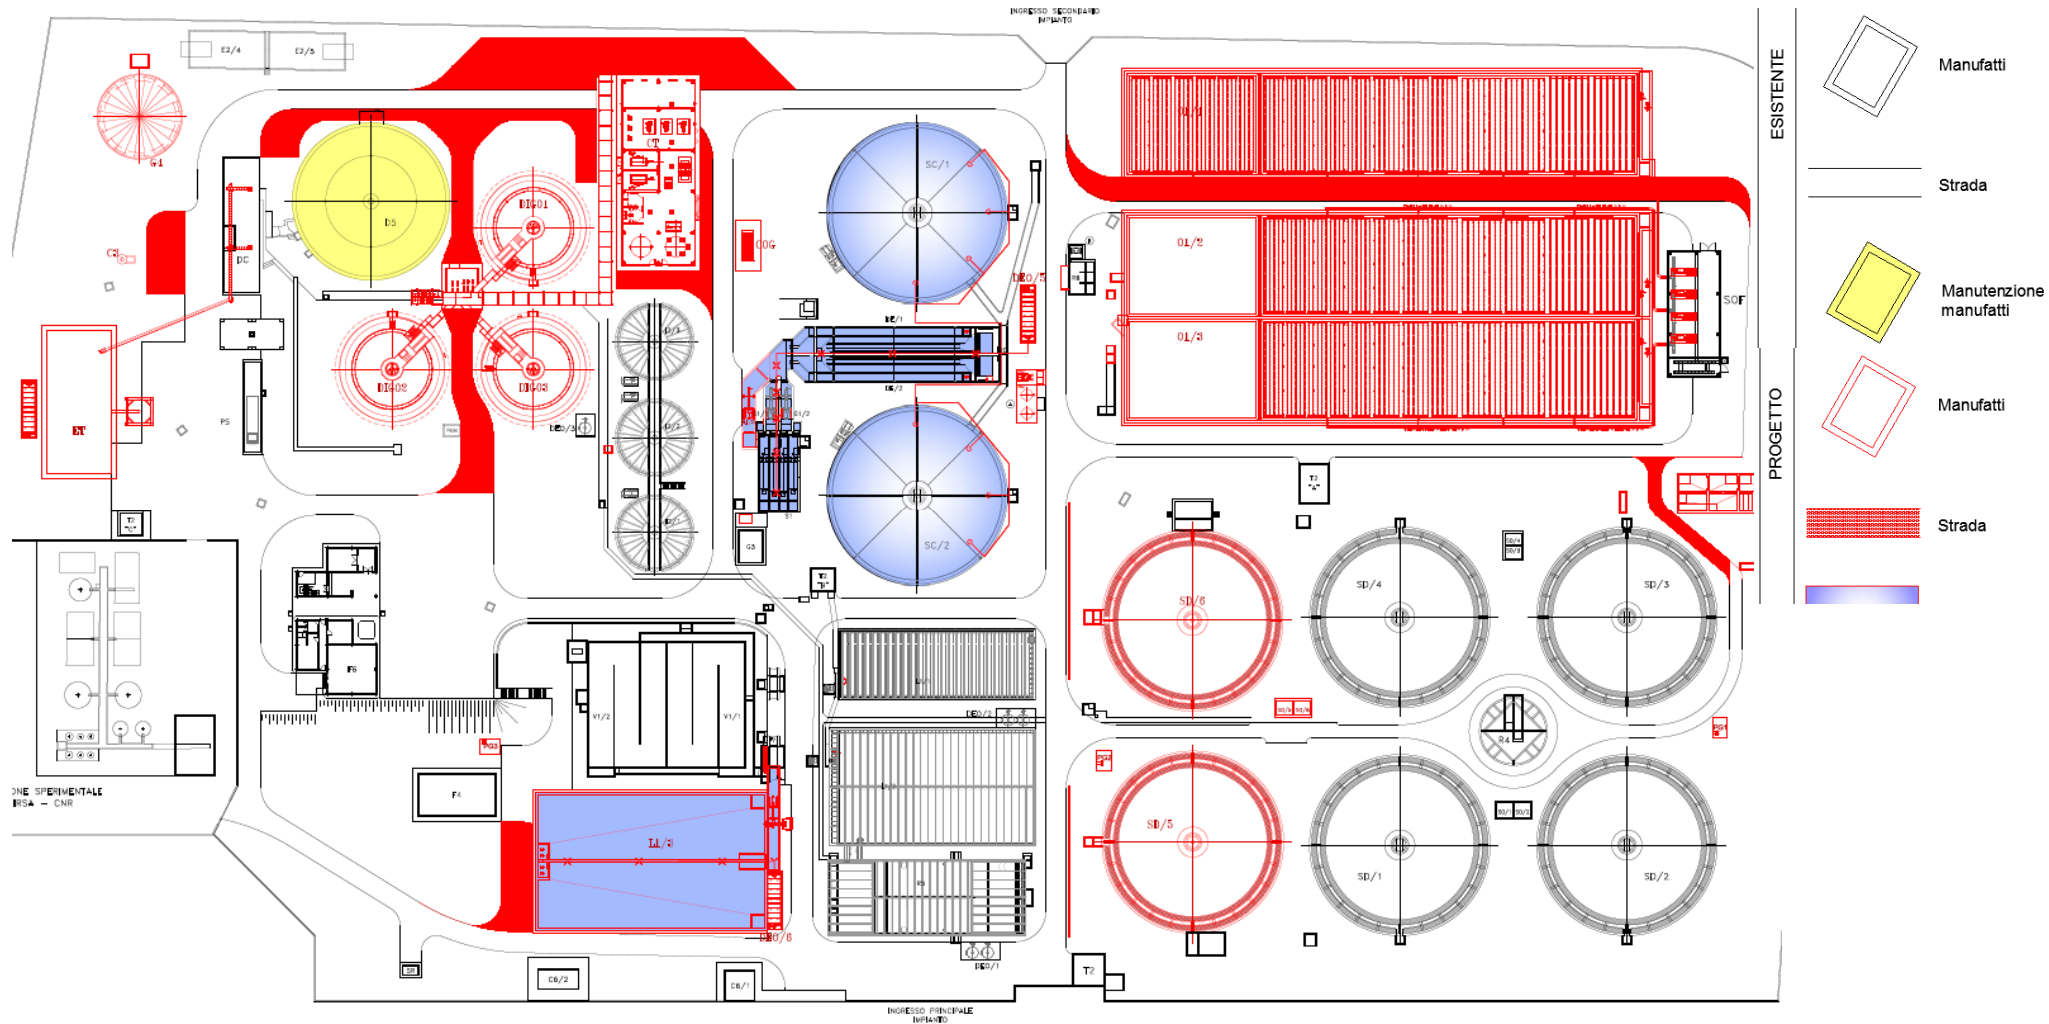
Impianto depurativo di Bari - Ovest - Planimetria stato di progetto
